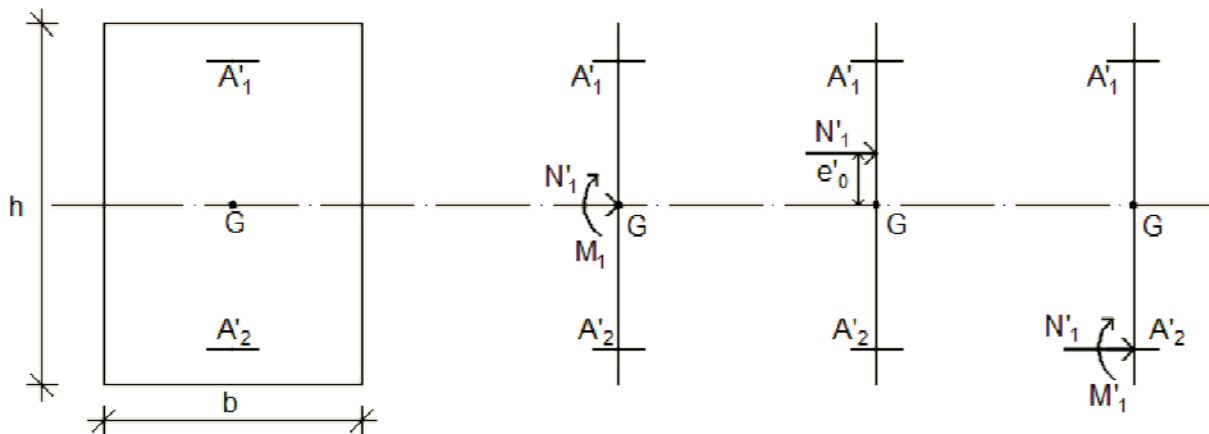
Position de N'_1 , M'_1 et M_1 sur la section transversale.
